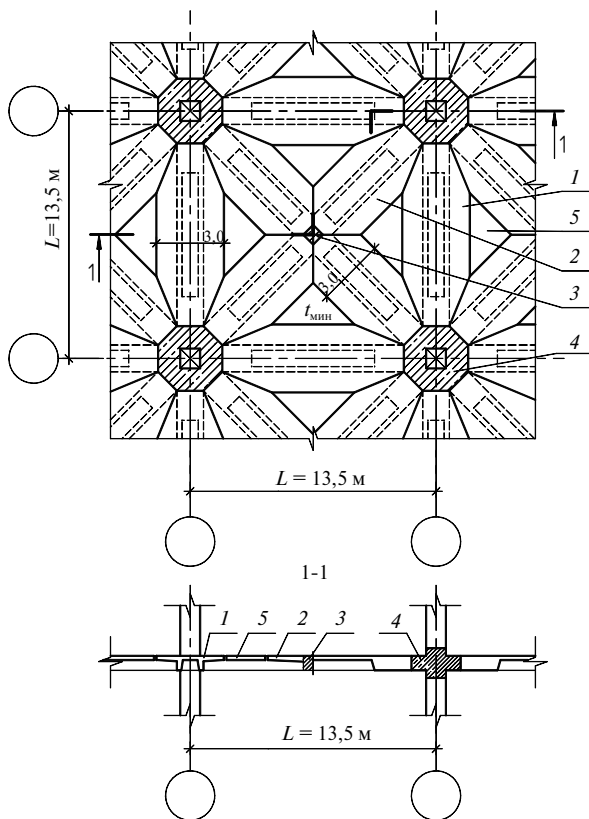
Перекрытие из сборных ребристых панелей, очерченных по форме грузовой площади ригелей. Схема расположения конструкций квадратной ячейки перекрытия размерами $13,5 \times 13,5$ м:
